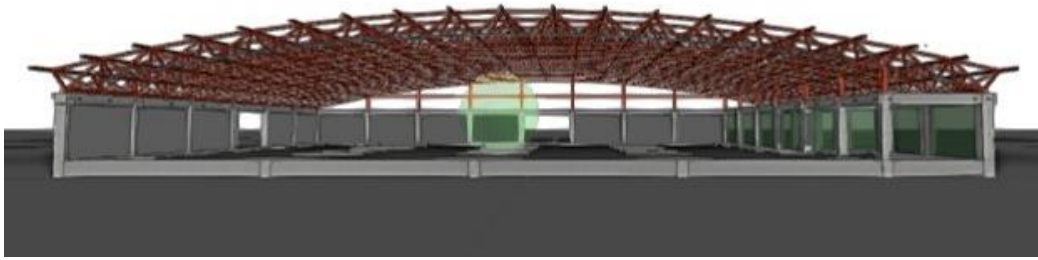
Sección por eje de simetría X visto a nivel rasante del suelo la planta comercial.
